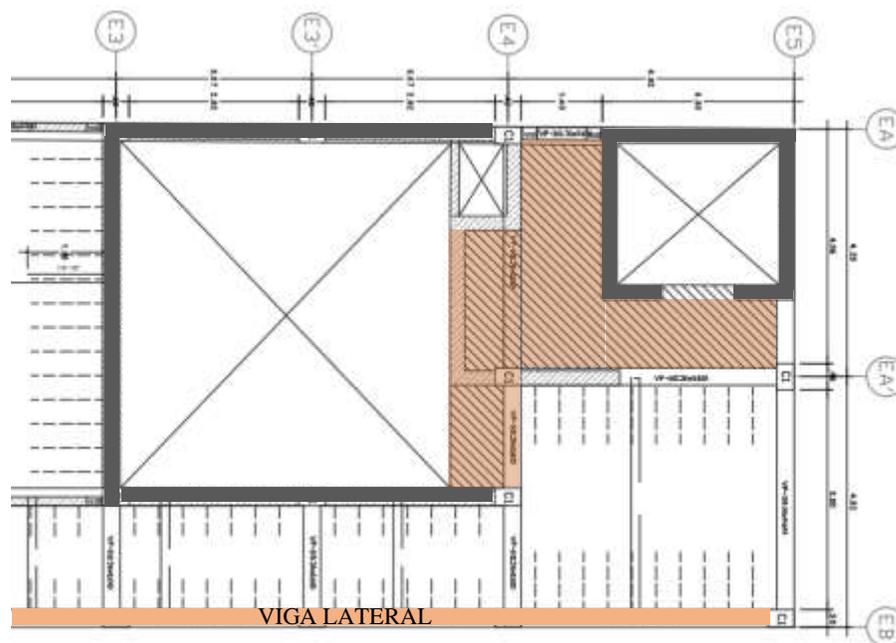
Diseño de losas, bloque e. Ver plano 61_E01_Plano de losa eje E. Elaboración propia.
